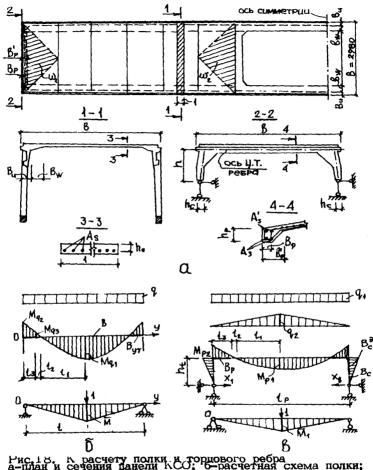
К расчету полки и торнового ребра а-план и сечения панели СО; б-расчетная схема полки; в-то же, торнового ребра
